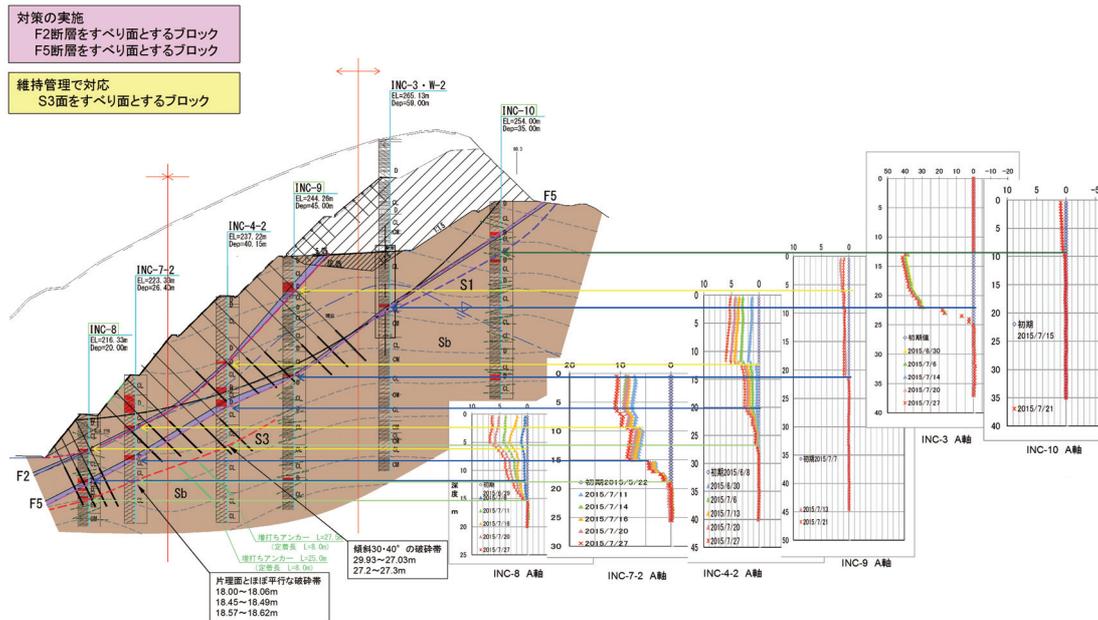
最終的な地質断面図と地盤変位 (STA.539+00)
